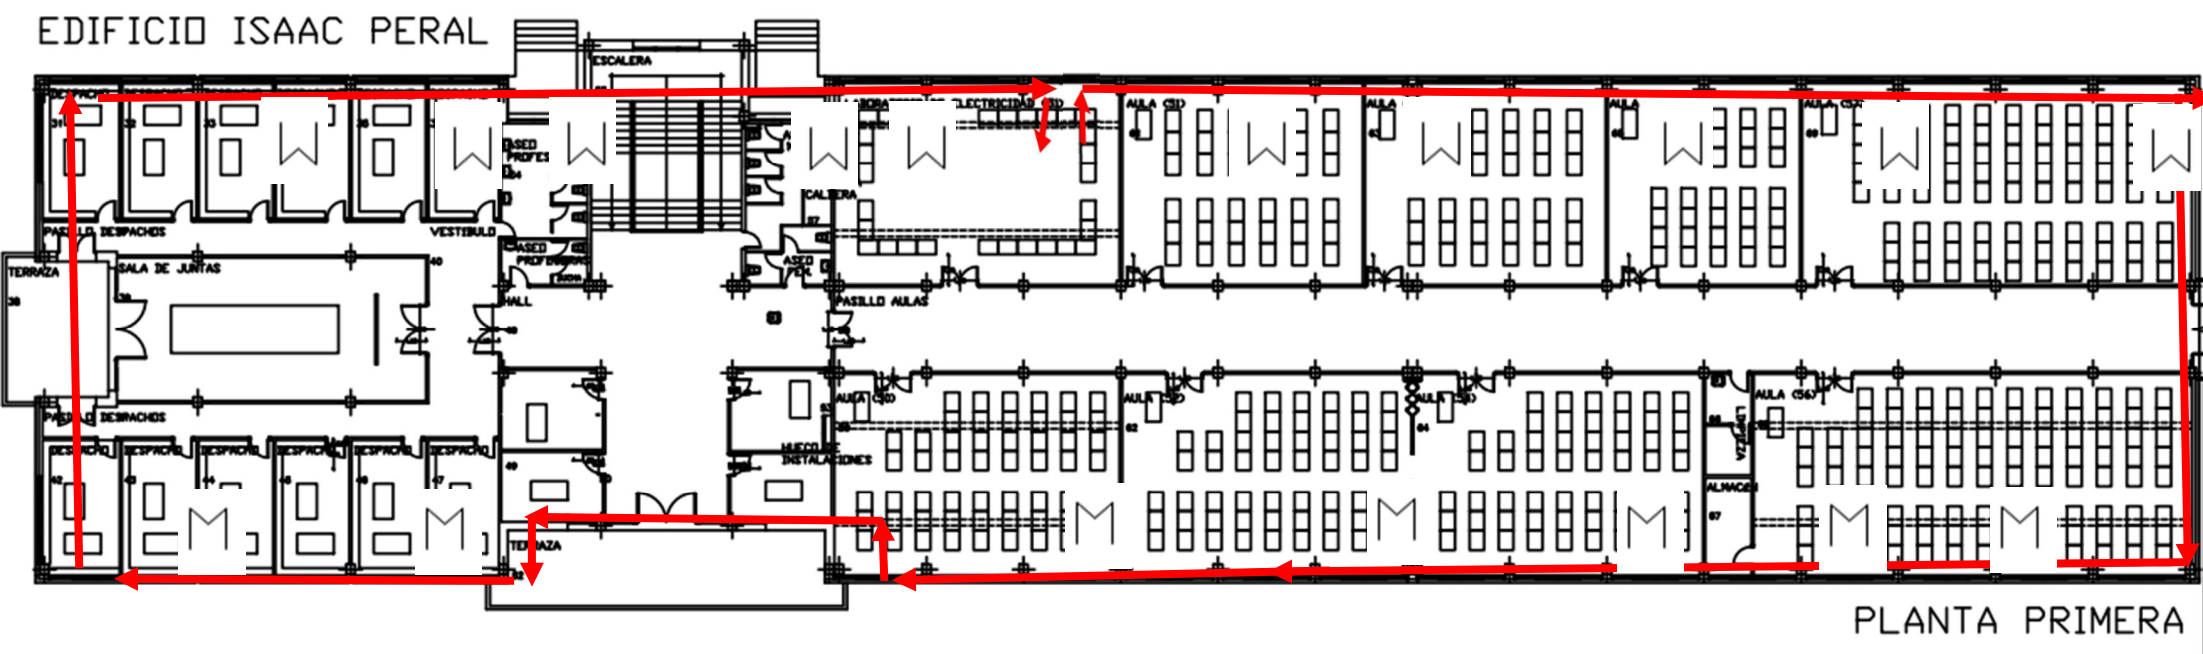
Esquema de instalación en primera planta. Elaboración propia
